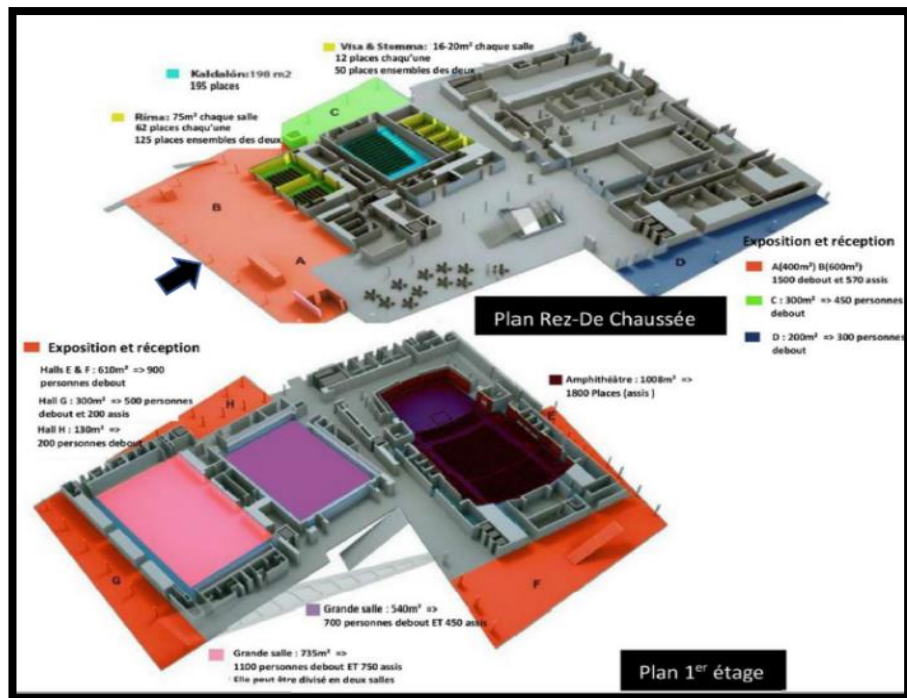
Plan de Rez de chaussée et 1ere étage du palais harpa
